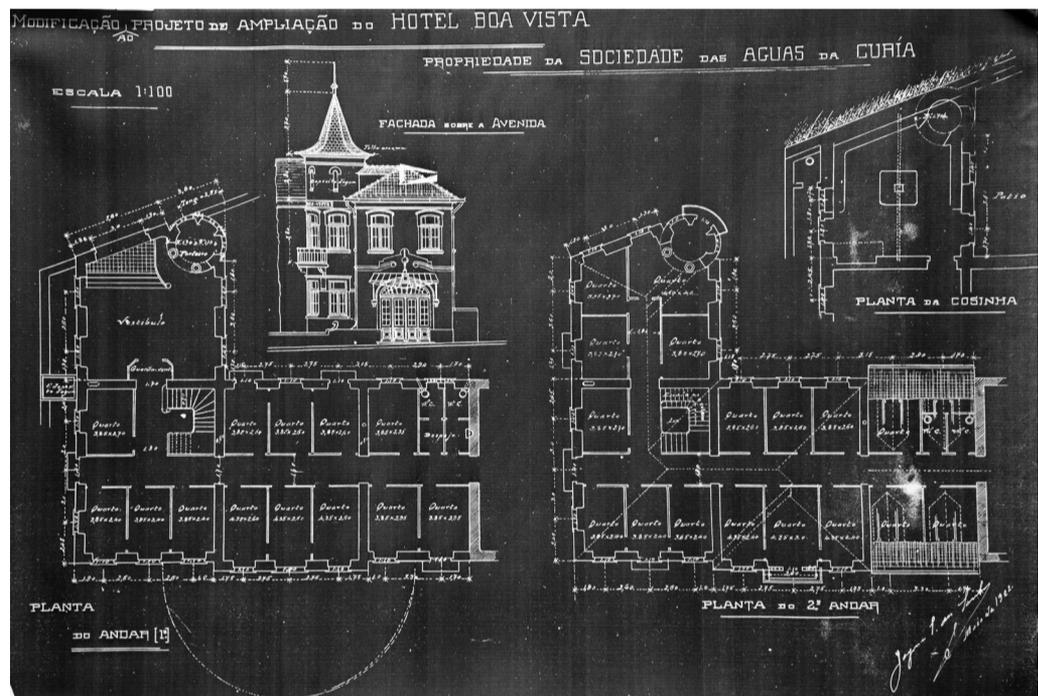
| Planta do hotel Boavista do arquiteto Jaime Inácio dos Santos (1922).
